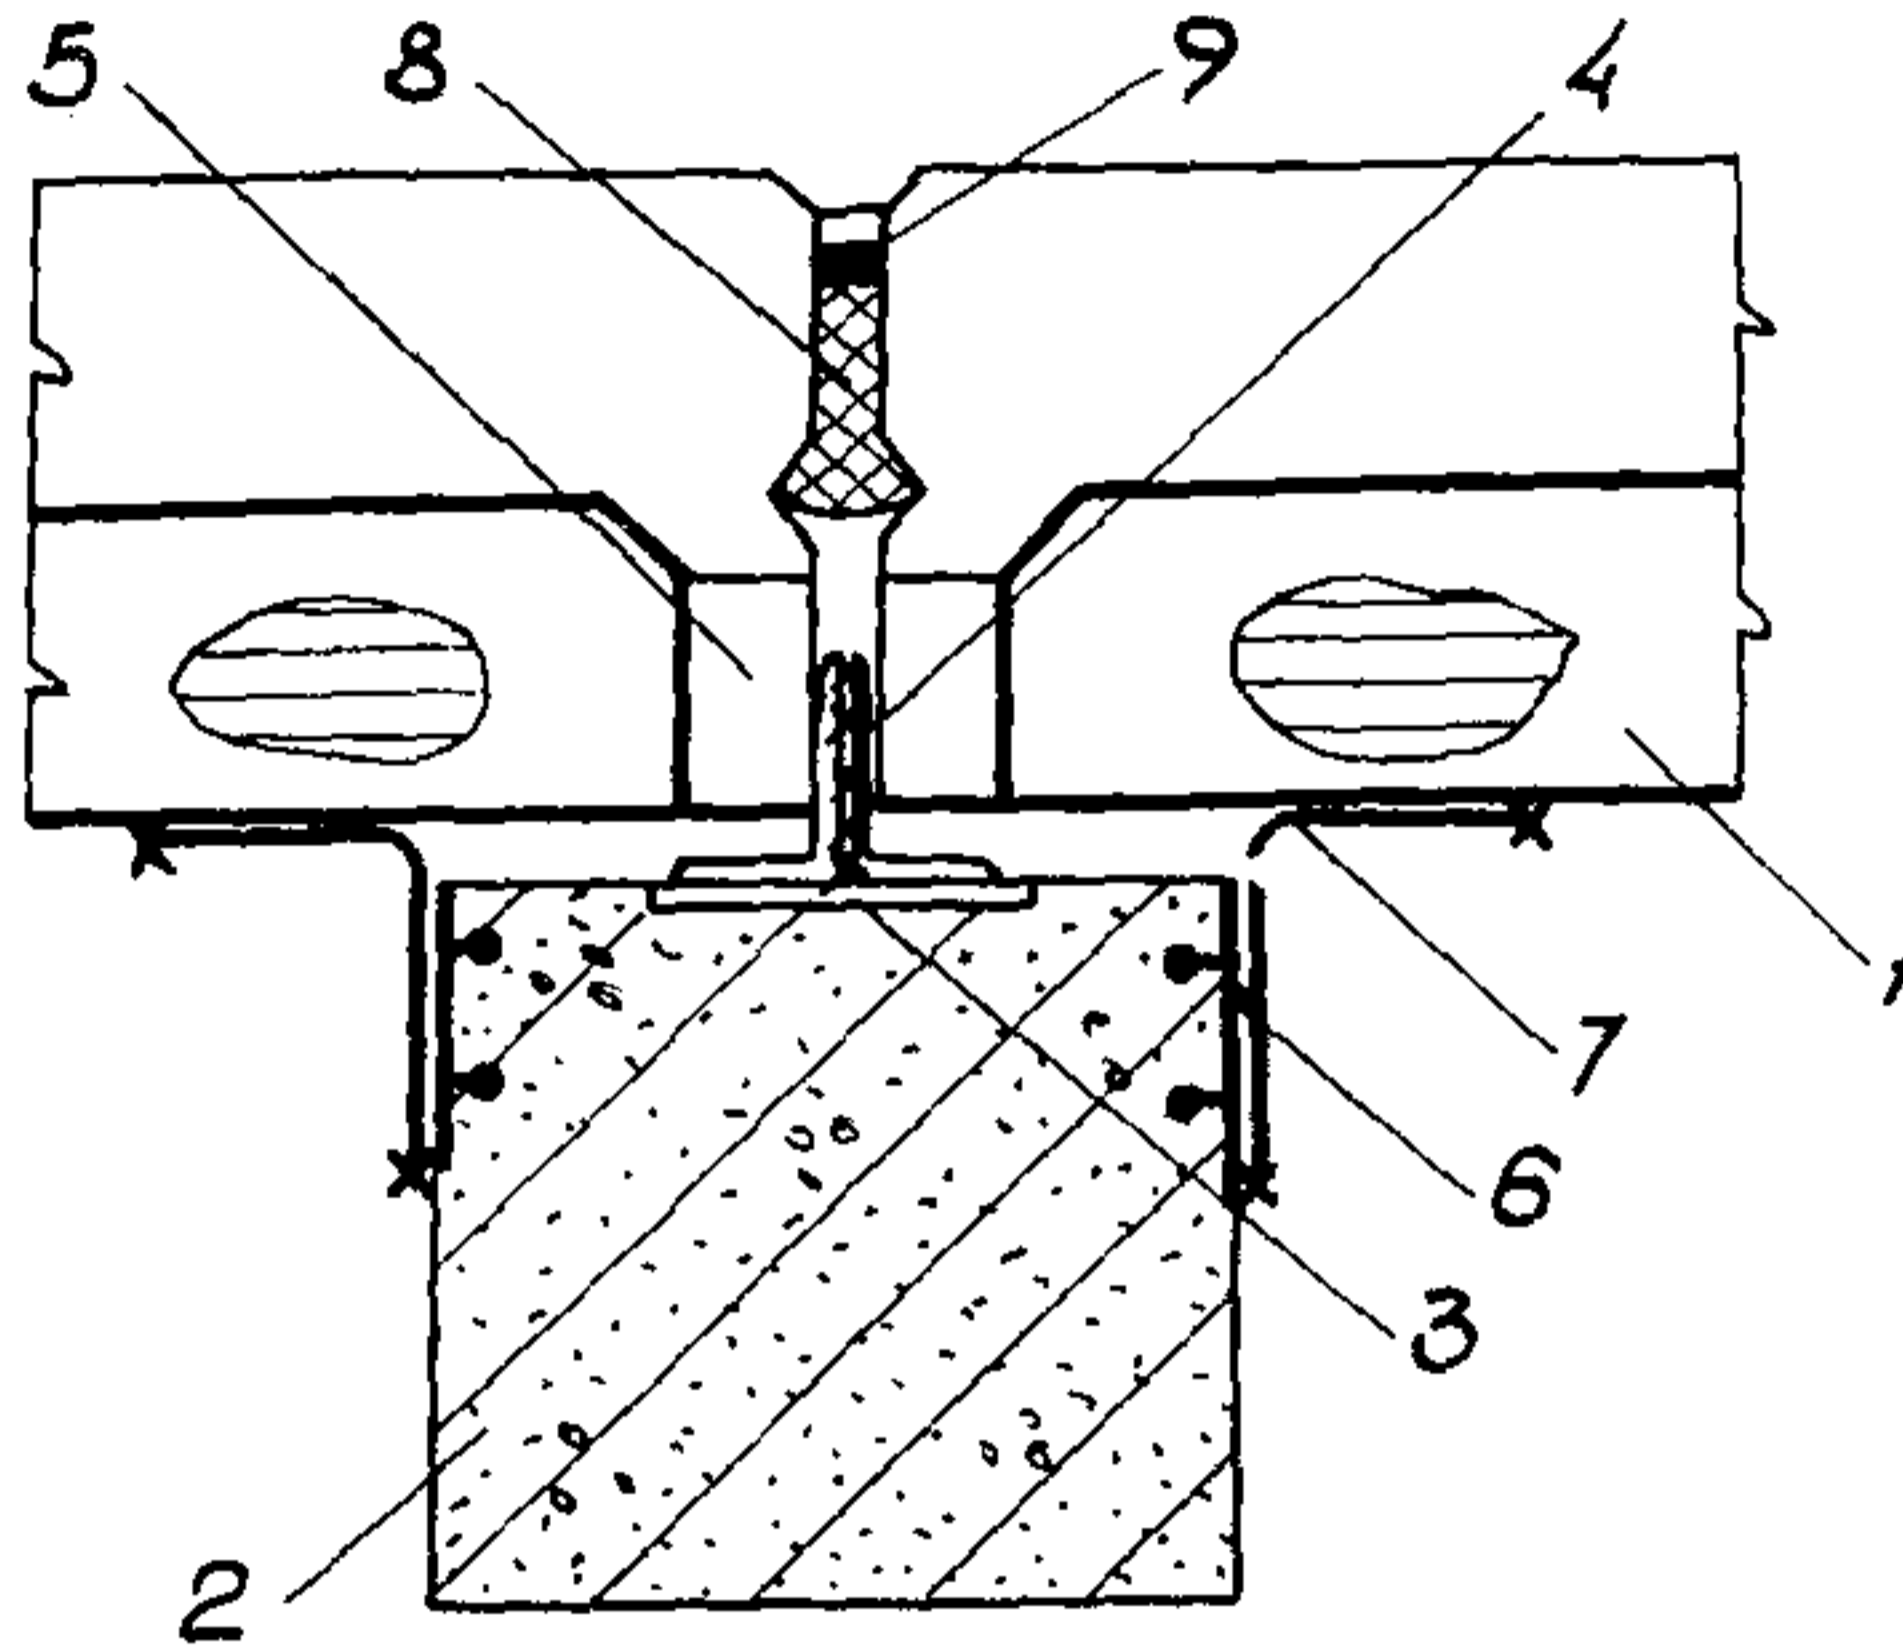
Крепление однослойных панелей к колонне при герметизации вертикальных стыков накладками из гладкого полиэтилена
